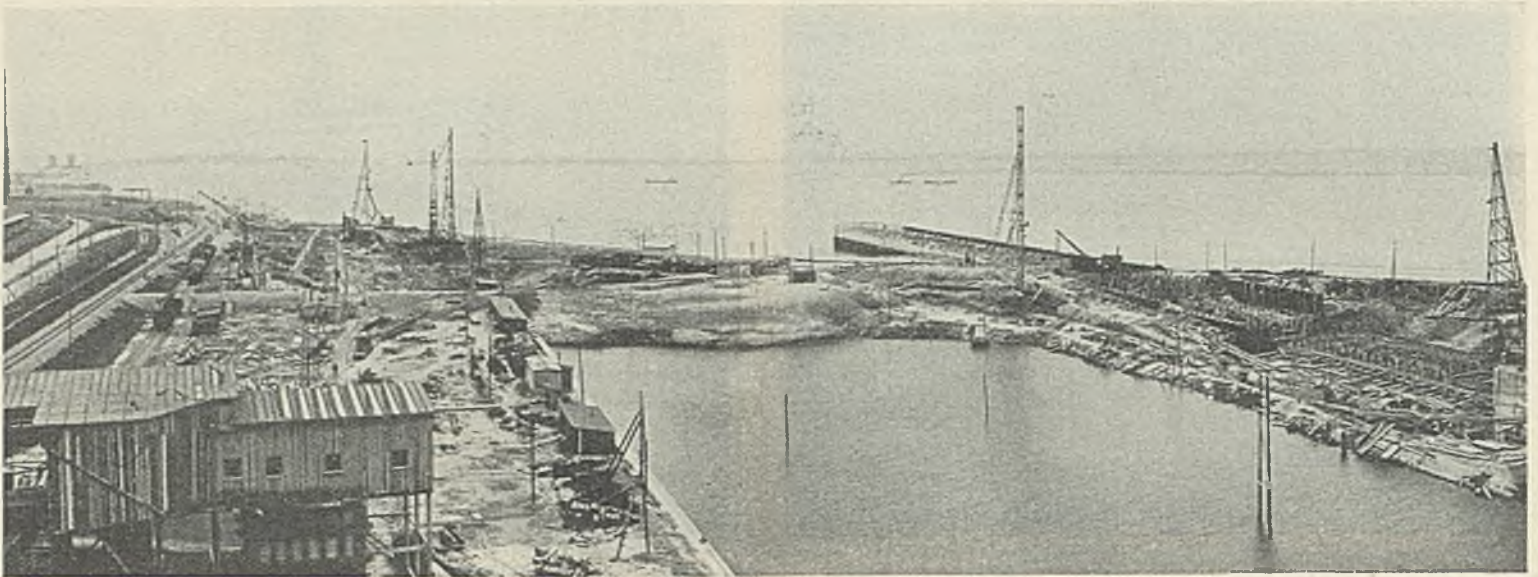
Durchbauung des Weserdeiches, Baustellenübersicht.
